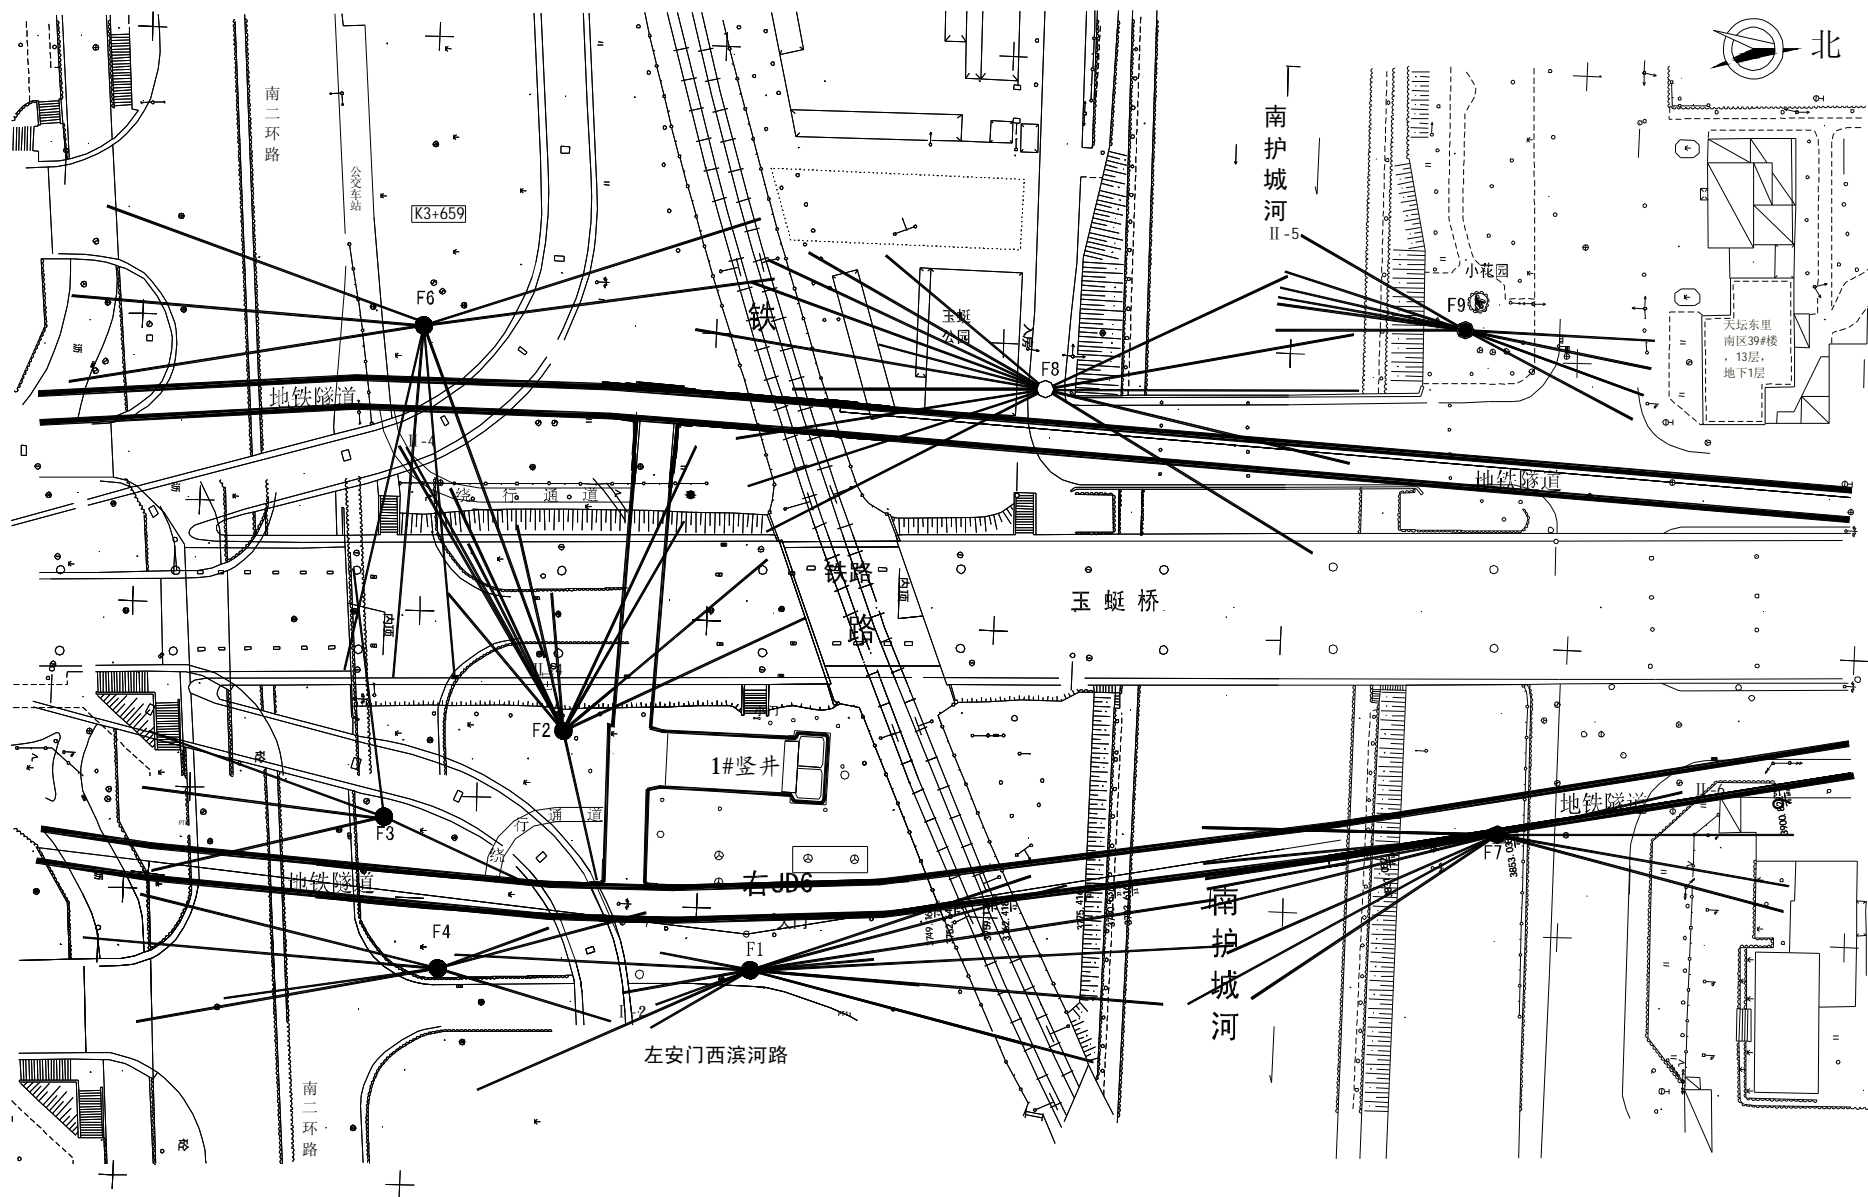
北京地铁五号线下穿玉蜓桥段辐射井降水平面图
